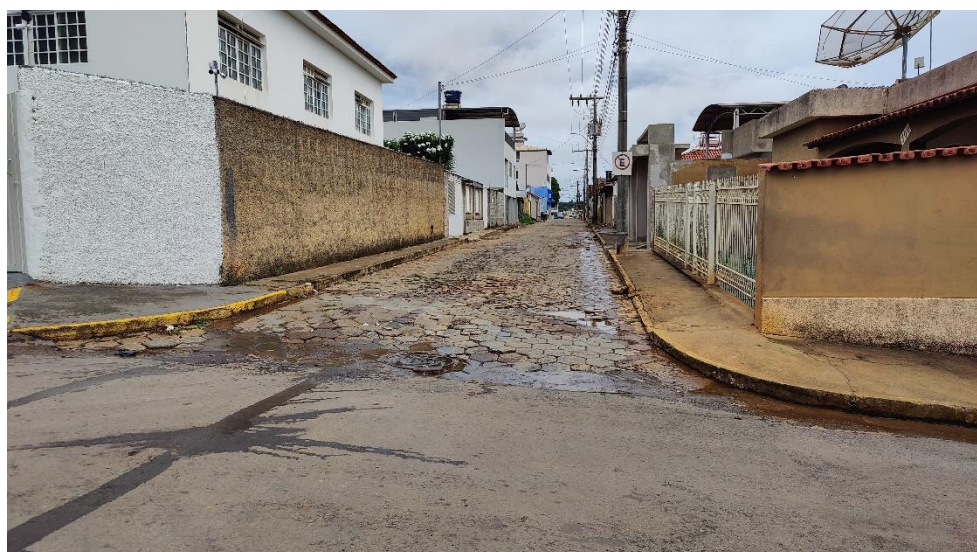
Rua Sidney de Oliveira, para execução da pavimentação.
